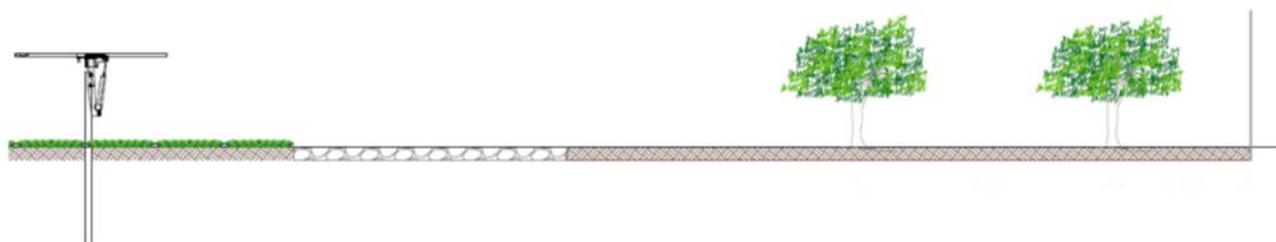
| layout impianto opere di mitigazione (Elab. RS06EPD01980A0)
